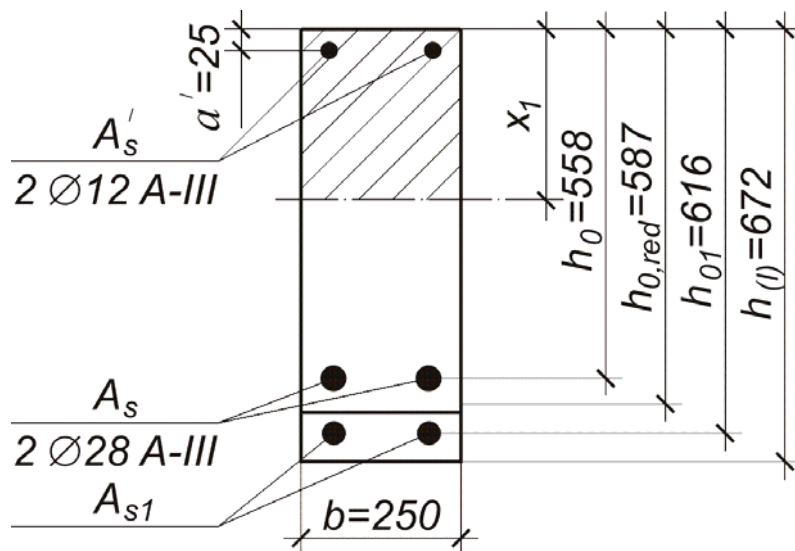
Расчетное сечение ригеля, усиленного дополнительной арматурой
